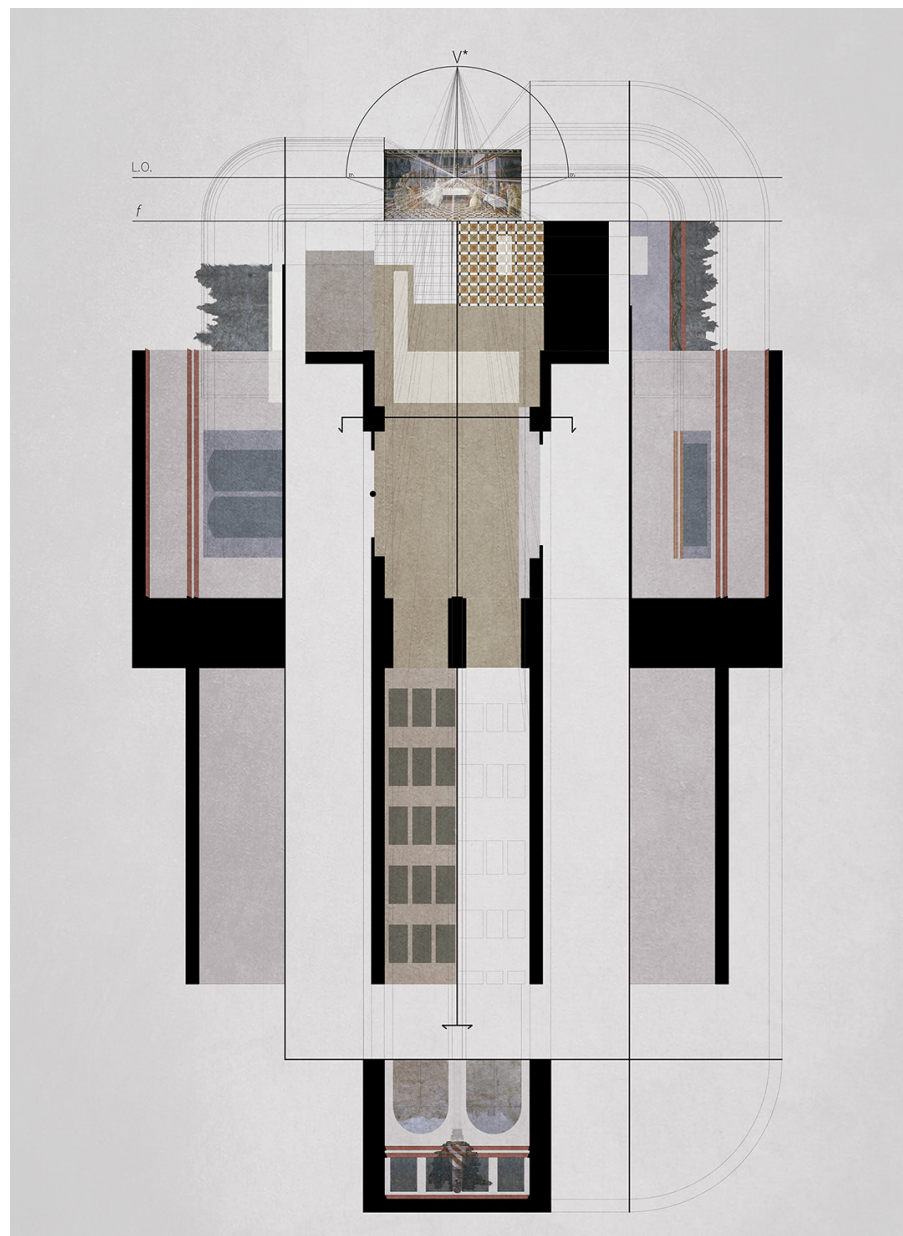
Restituzione prospettica di pianta, sezioni e ipografia dello spazio dipinto da Lippi.
